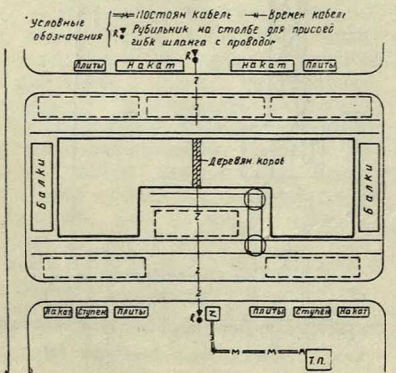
Размещение балок, ж.-б. плит и наката и подводки энергии для питания крана
